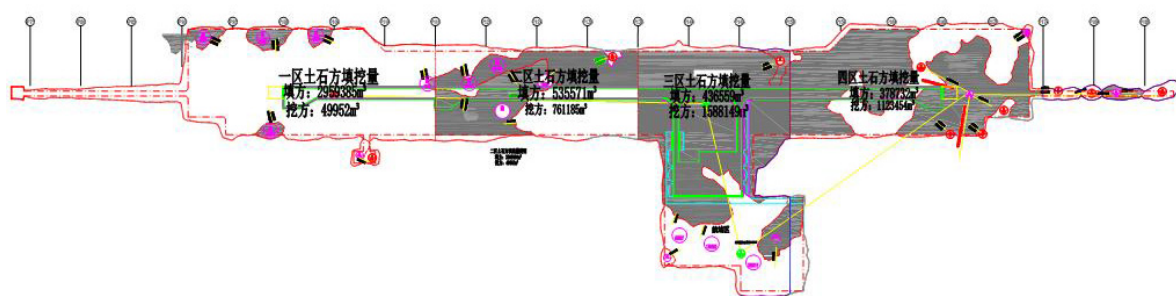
分区块施工示意图（图中灰色为挖方，空白处为填方）
